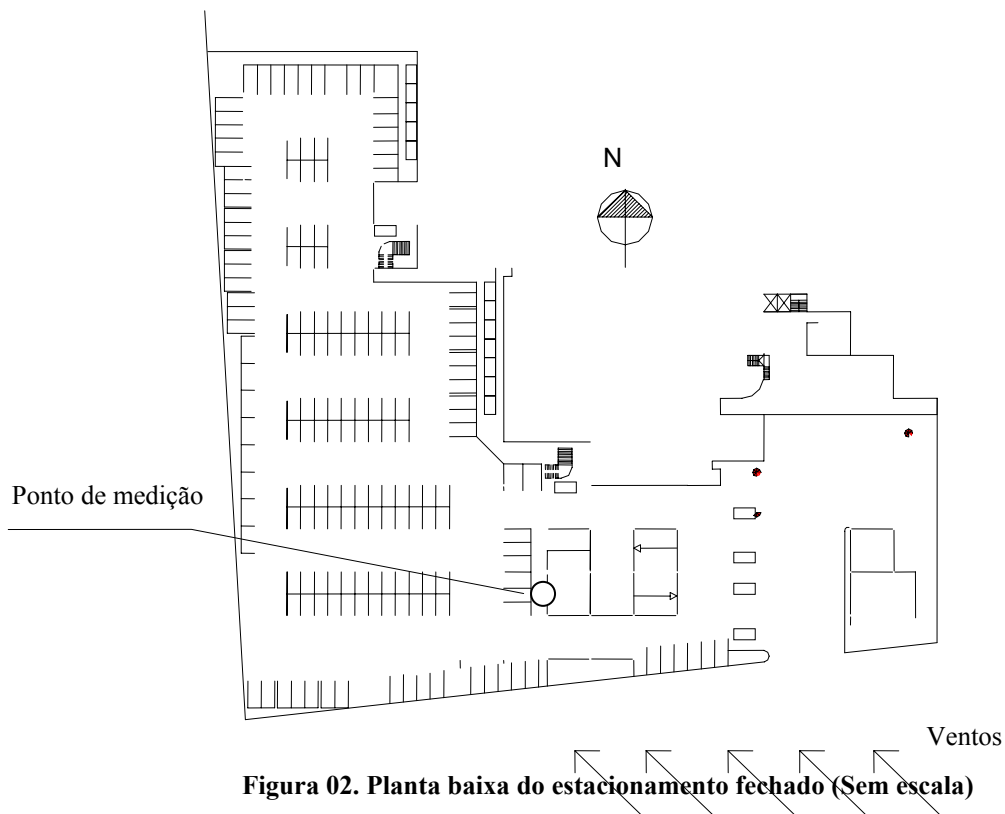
Planta baixa do estacionamento fechado (Sem escala)
